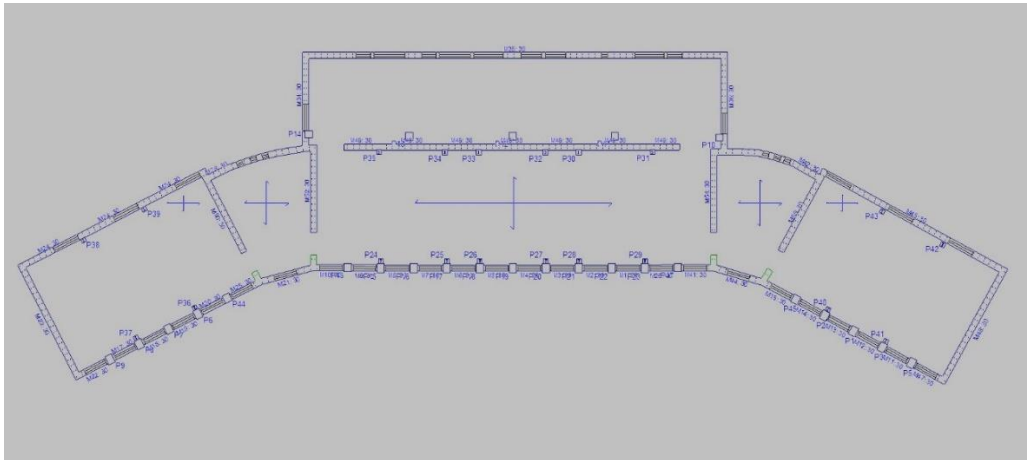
Planta 2 del modelo de 5 plantas simplificado
